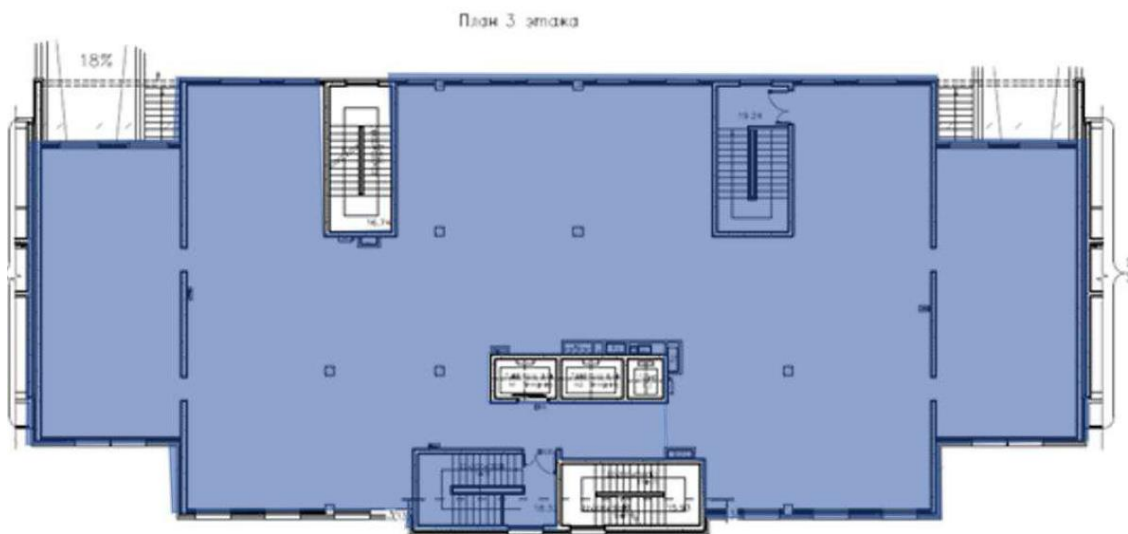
План 3 этажа БС-13 ЖК URAL
